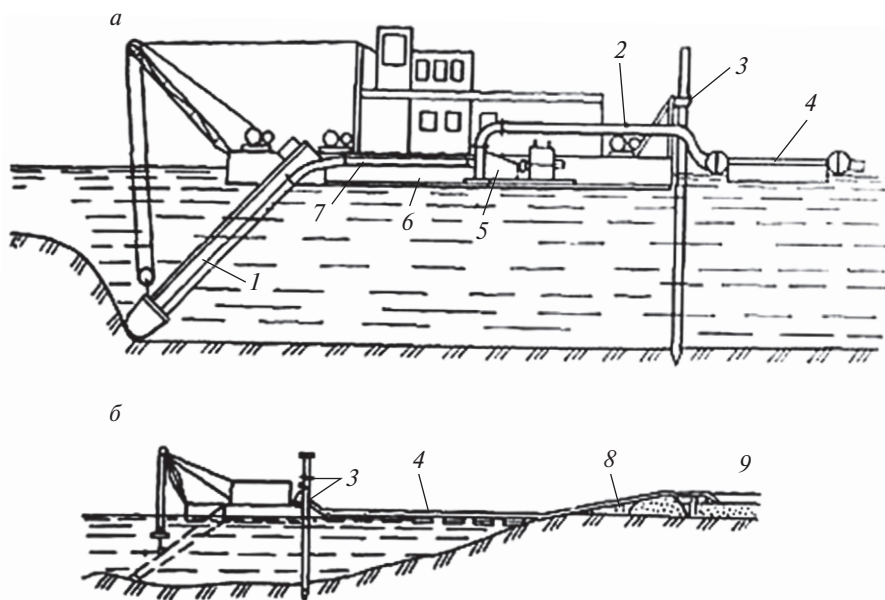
Разработка грунта землесосным снарядом (<http://delostroika.ru>, 2008):
